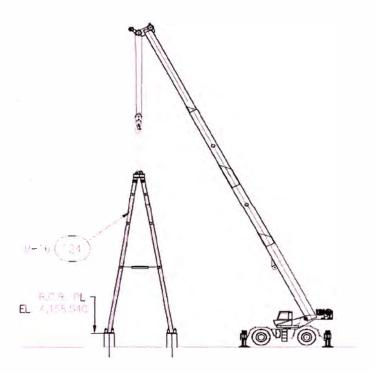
Posición de equipos para maniobra de montaje de la cepa B16
